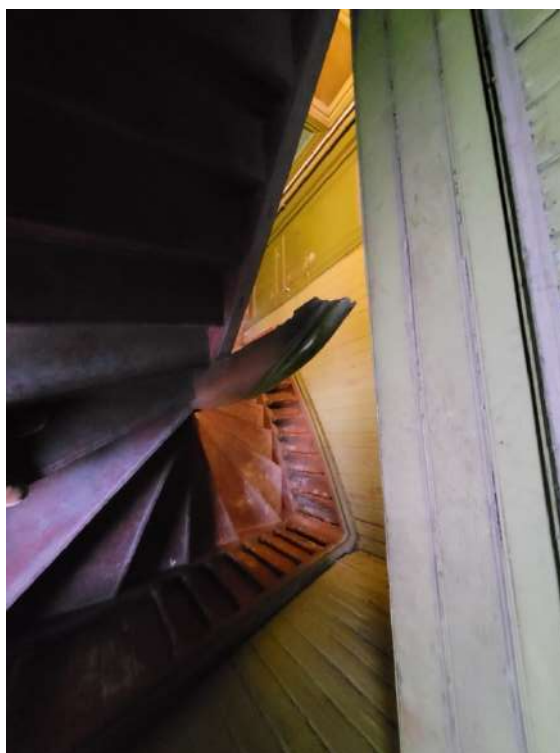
Hoovipoolne trepp (Autori foto, 2023)
